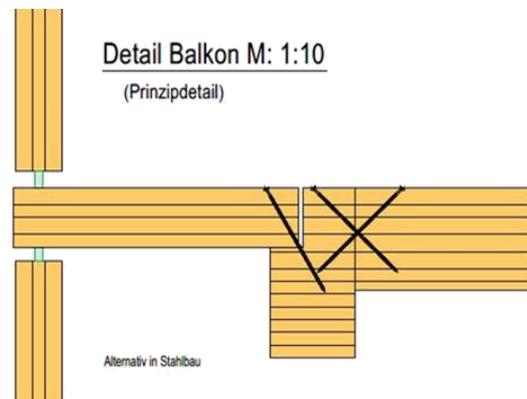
Anschluss Balkonkonstruktion [B. Walter Ingenieurgesell. mbH]
